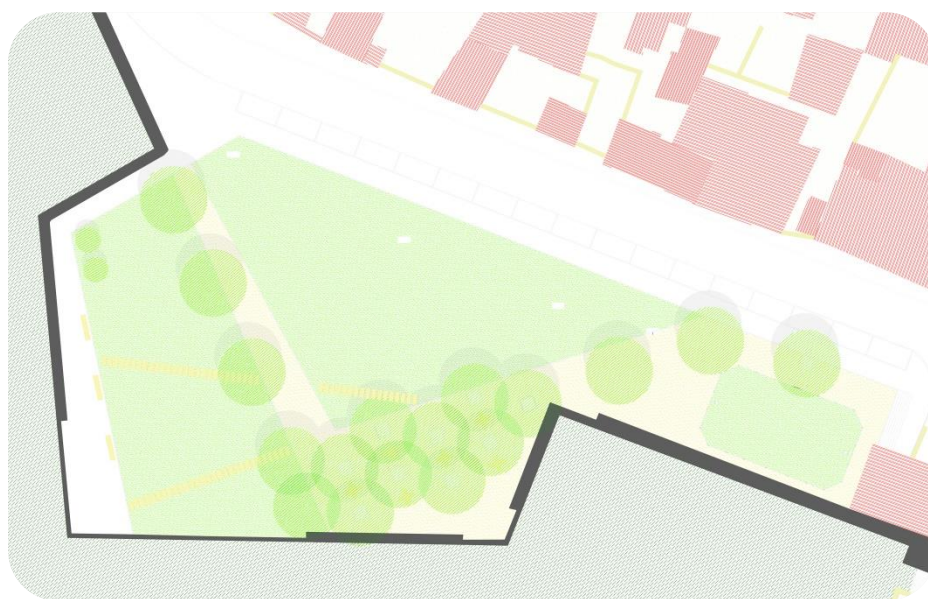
Planta Alternativa do Baluarte de Santiago – sem escala
